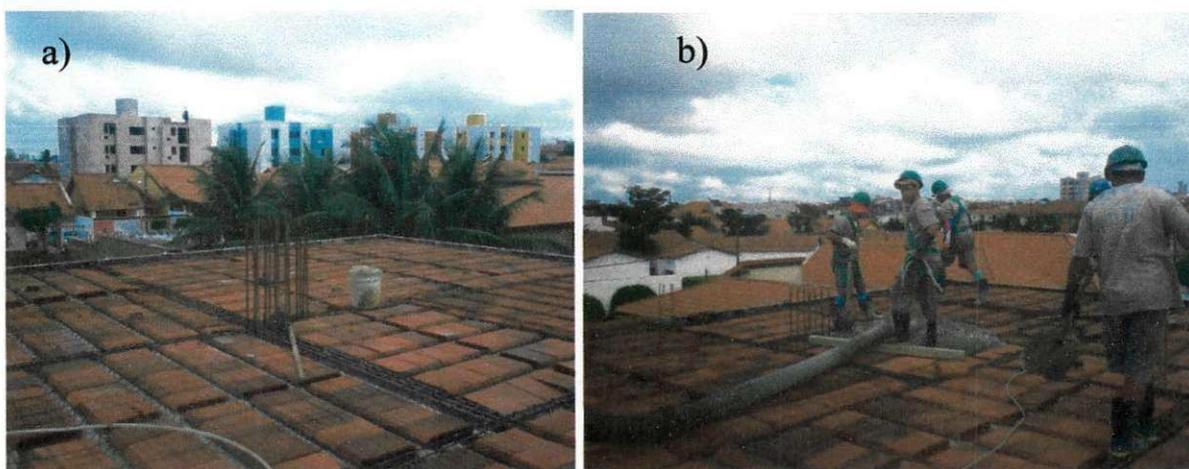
a) mangueira molhando a laje; b) Início da concretagem.
